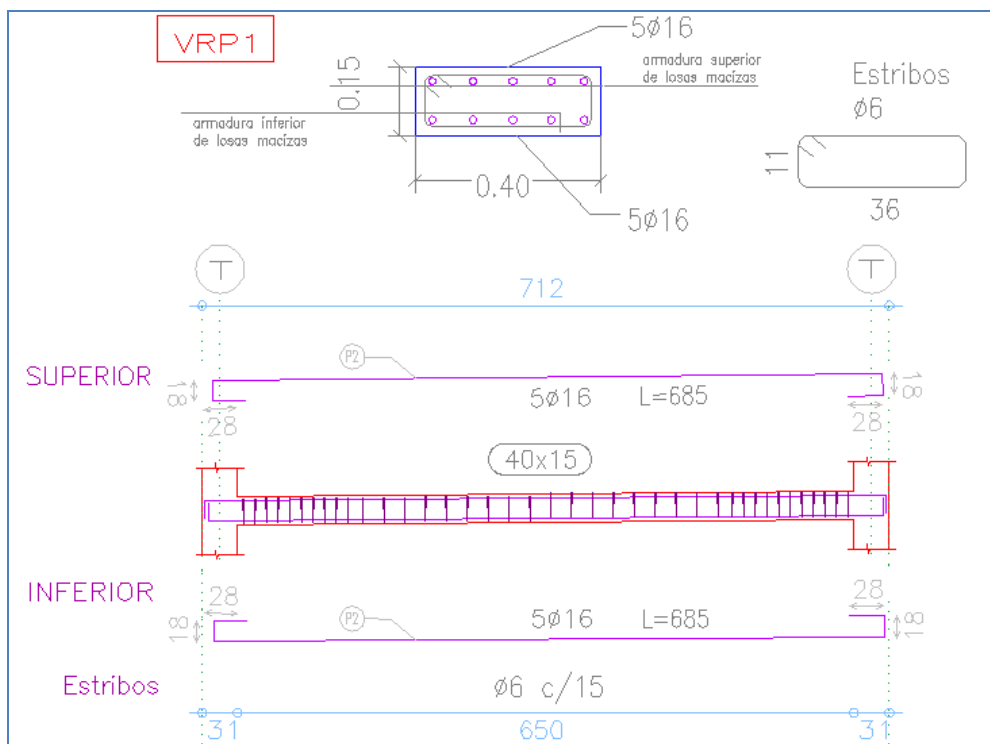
Detalle de armado de una viga de apoyo de la rampa de circulación.
